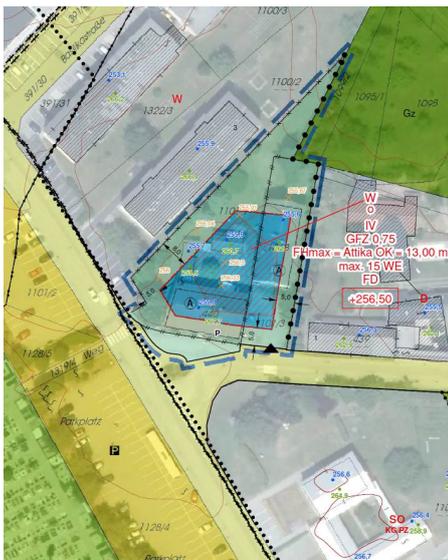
Planungsgegenständlicher Bebauungsplan Nr. 85 (Stand: 20.06.2023)
